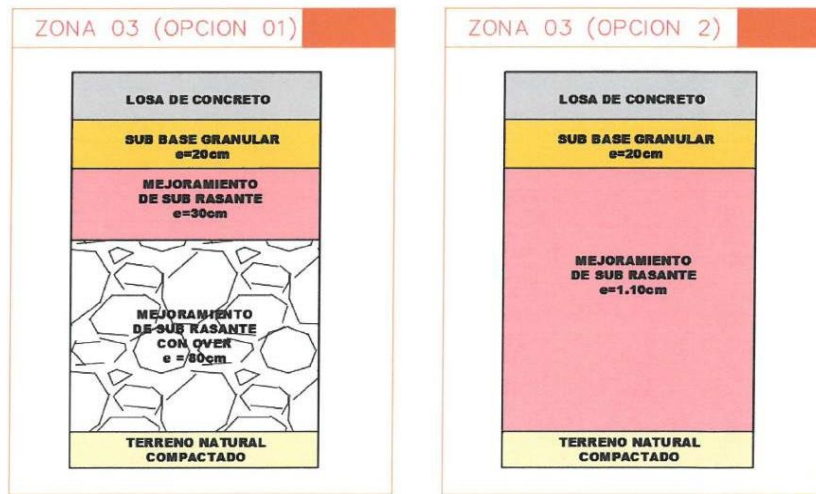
Sección recomendada de pavimento ZONA 03. Fuente: Elaboración Propia.
